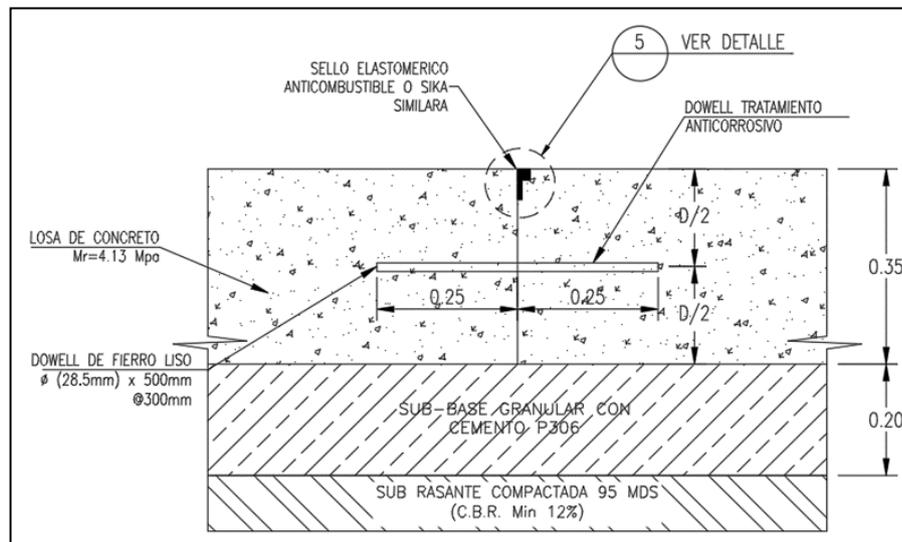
Sección Típica de Pavimento ingreso Avianca.
